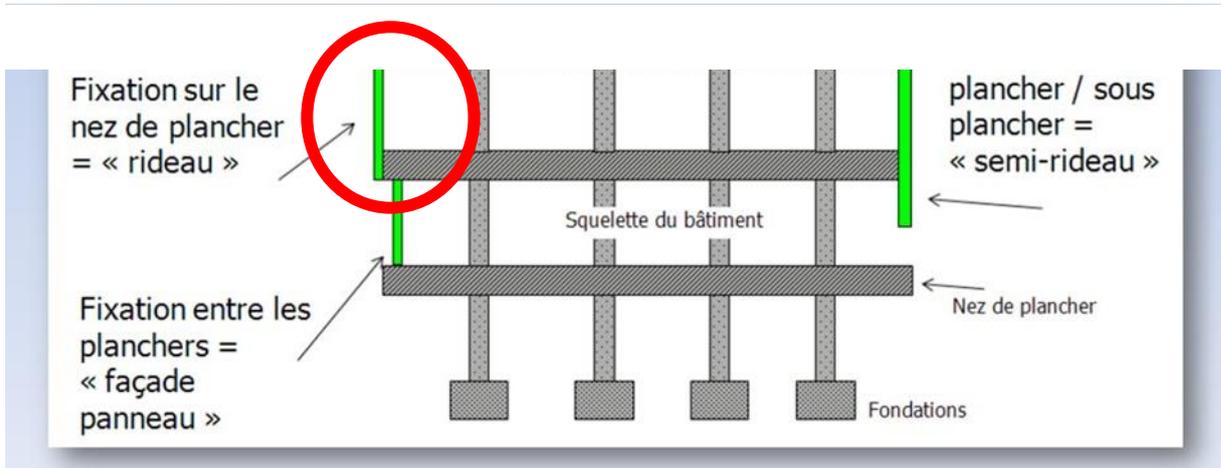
La façade rideau: nez de plancher/sous plancher
